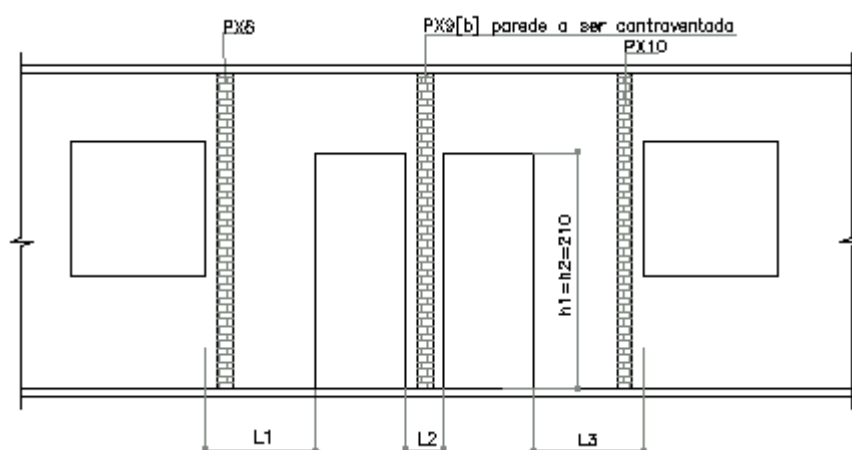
Comprimento mínimo da parede de travamento [PY18].
